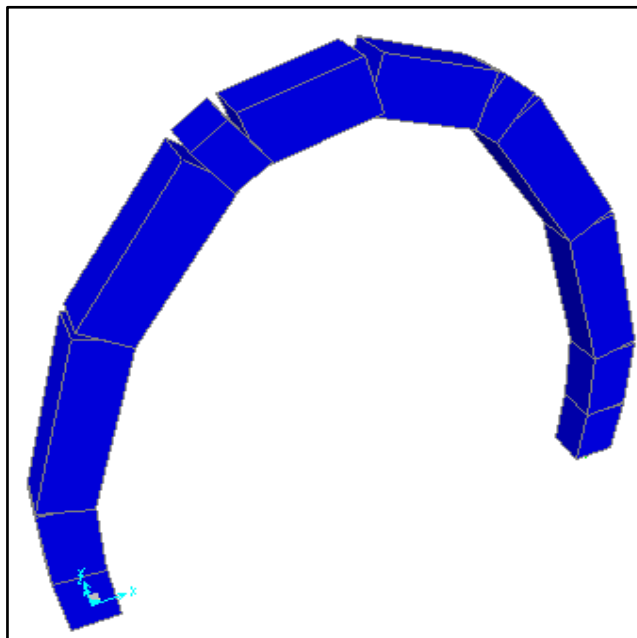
Modelo de la geometría de la cercha de hormigón y condiciones de apoyo.
